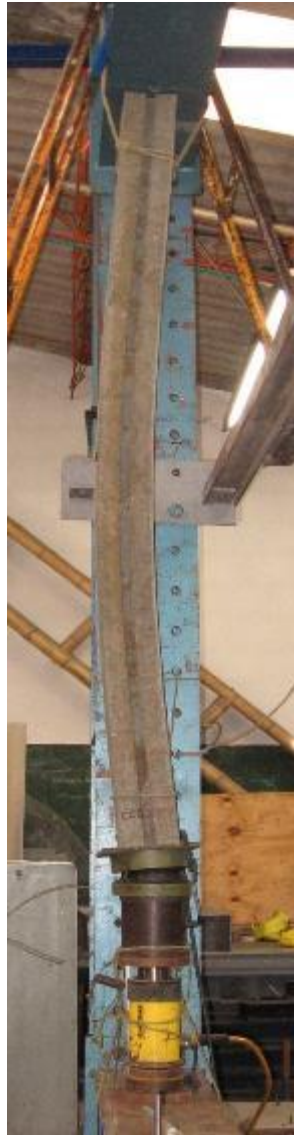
Modo de falla por pandeo de columna de 2,40m en ensayo a compresión.
